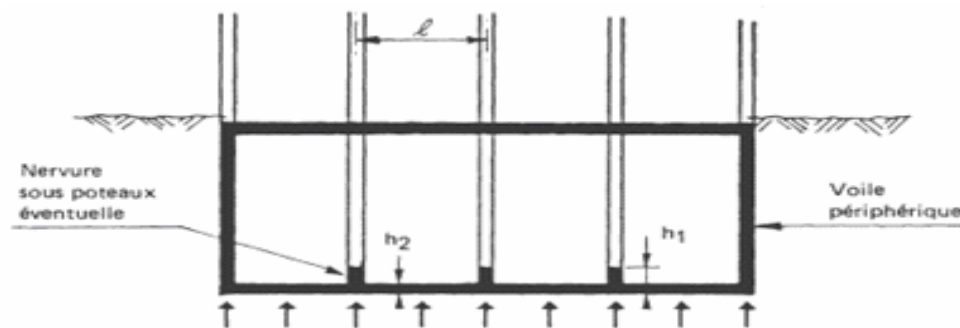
Disposition des nervures par rapport à la dalle et aux poteaux
